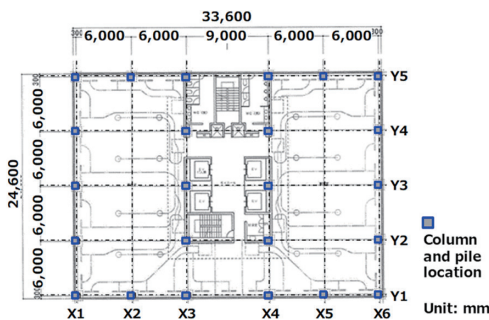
平面図、柱・杭配置図<sup>6)</sup>を改変
